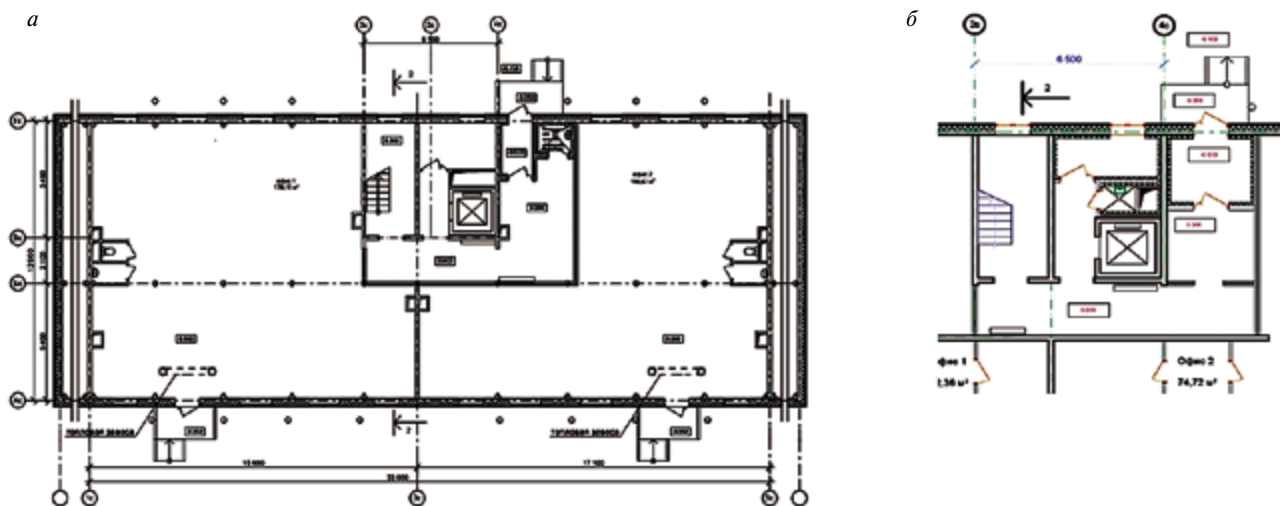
Свободная планировка 1-го этажа (а); план входа на 1 этаж практически с уровня земли (б)
